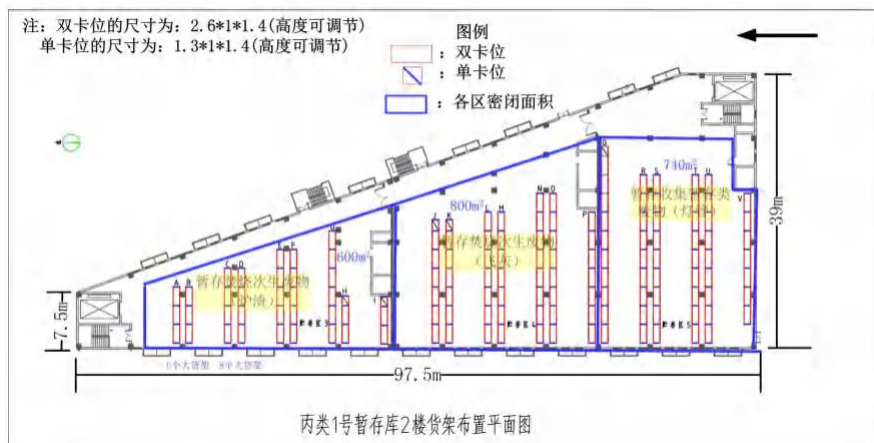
现有项目 1 号丙类暂存库 2 楼平面布置图
